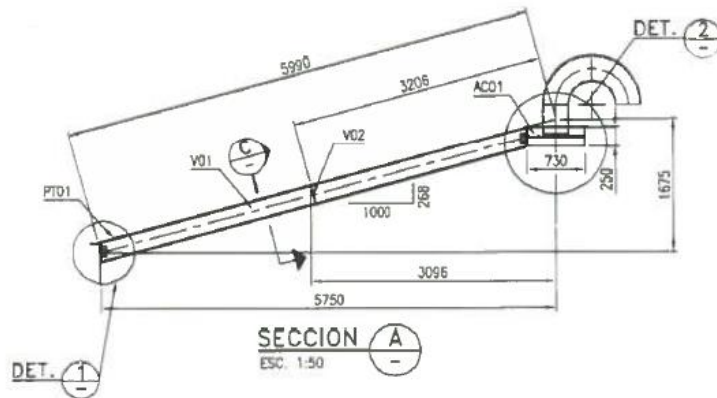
Extracto de plano del techo. Vista de corte en elevación.
